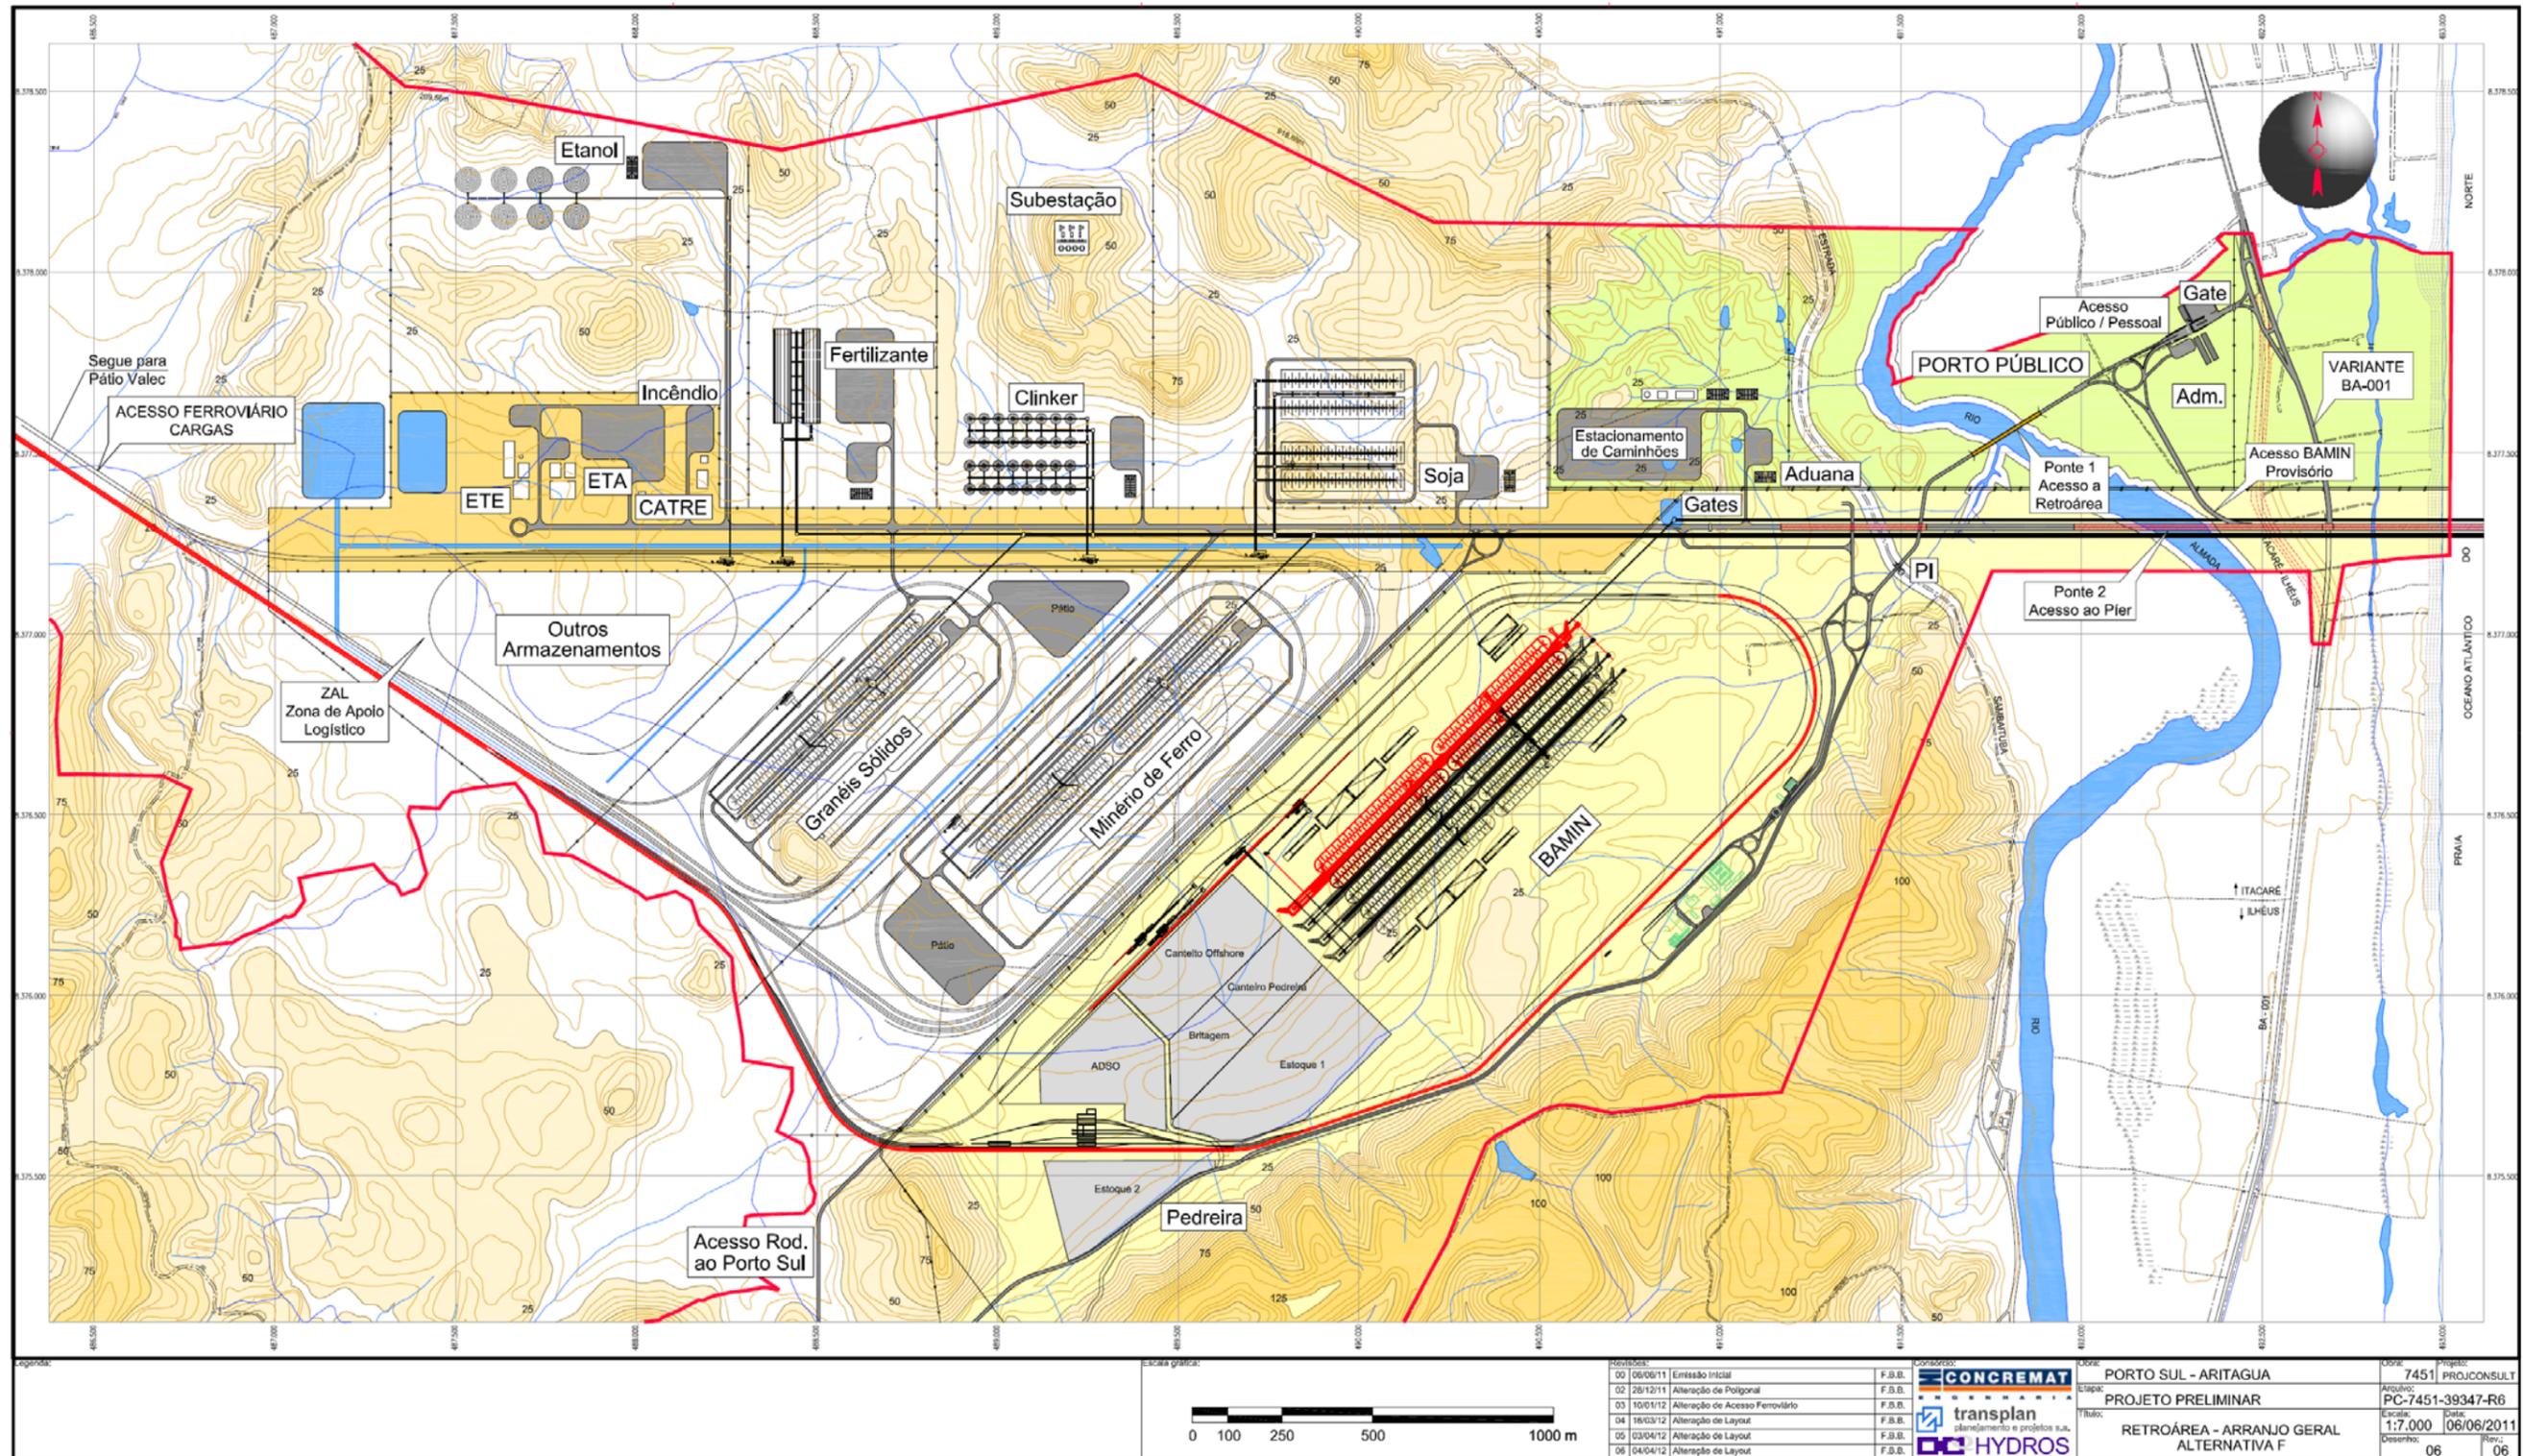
Planta Planialtimétrica Porto Sul – Estruturas Onshore
